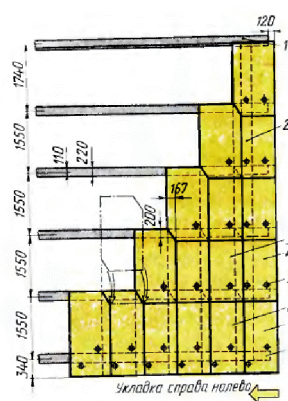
Укладка покрытия кровли из листов УВ-6-К с совмещением продольных кромок:
